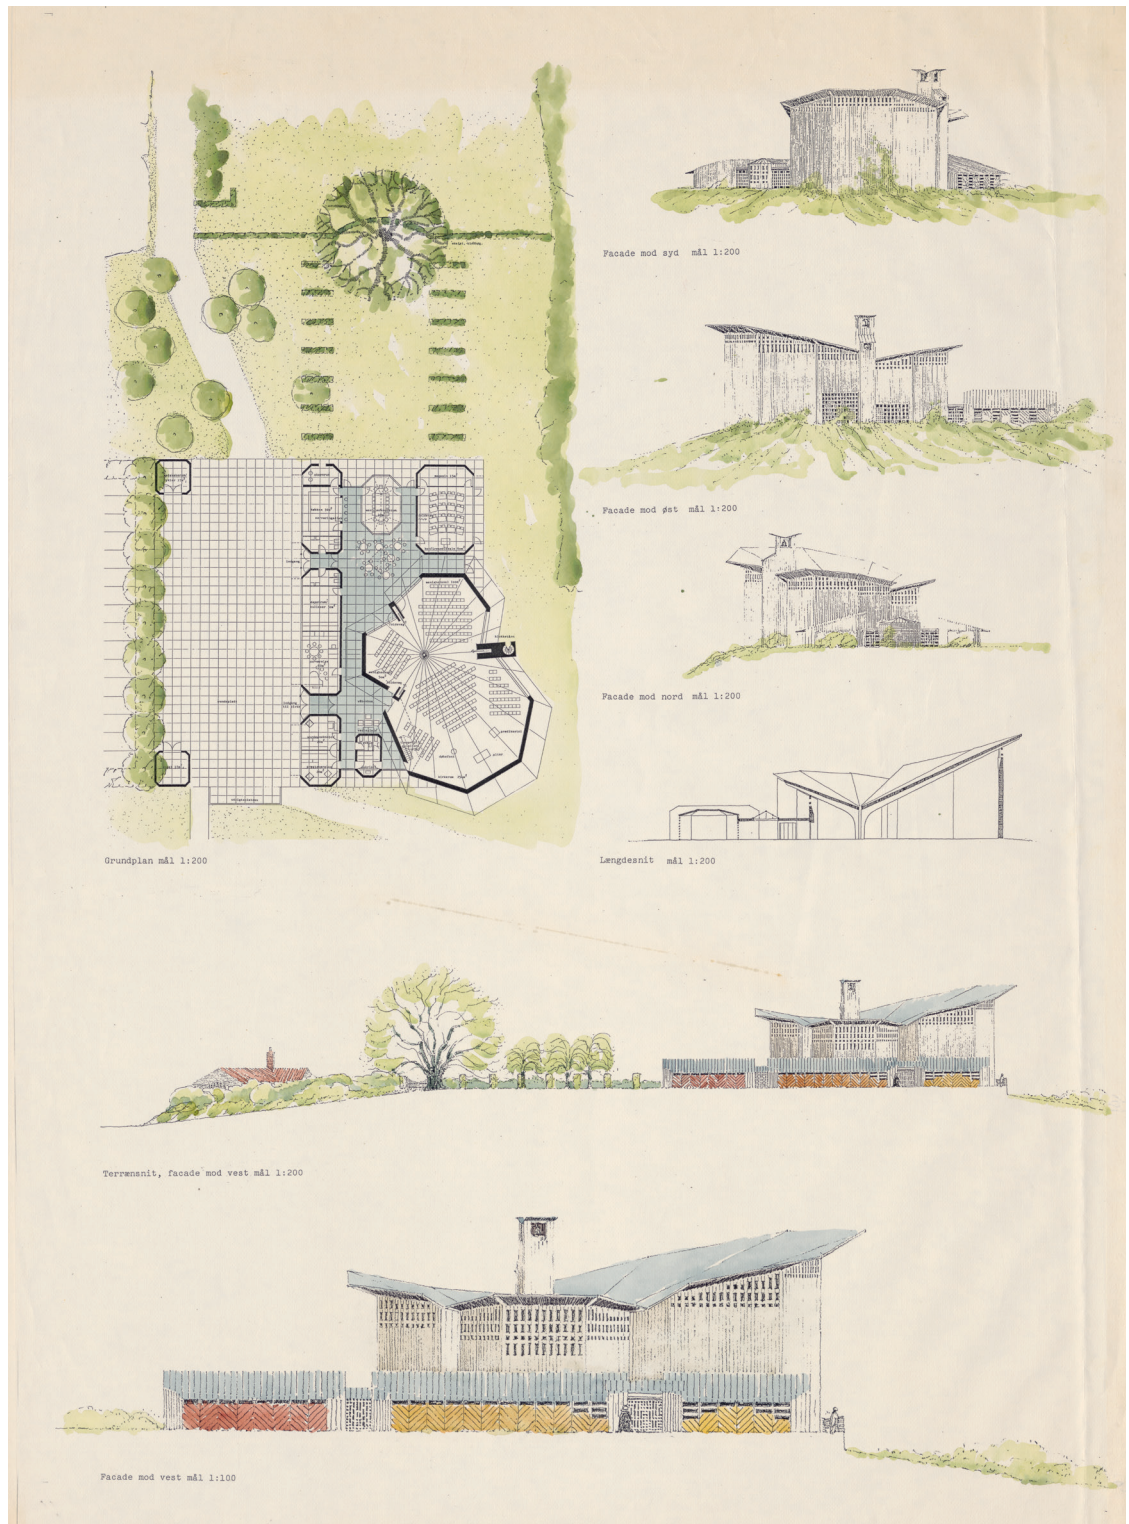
Plan, snit og opstalter. 1:1000/1:500. Inger og Johannes Exner 1994. I Danmarks Kunstmuseet. – *Plan, section and elevations.
